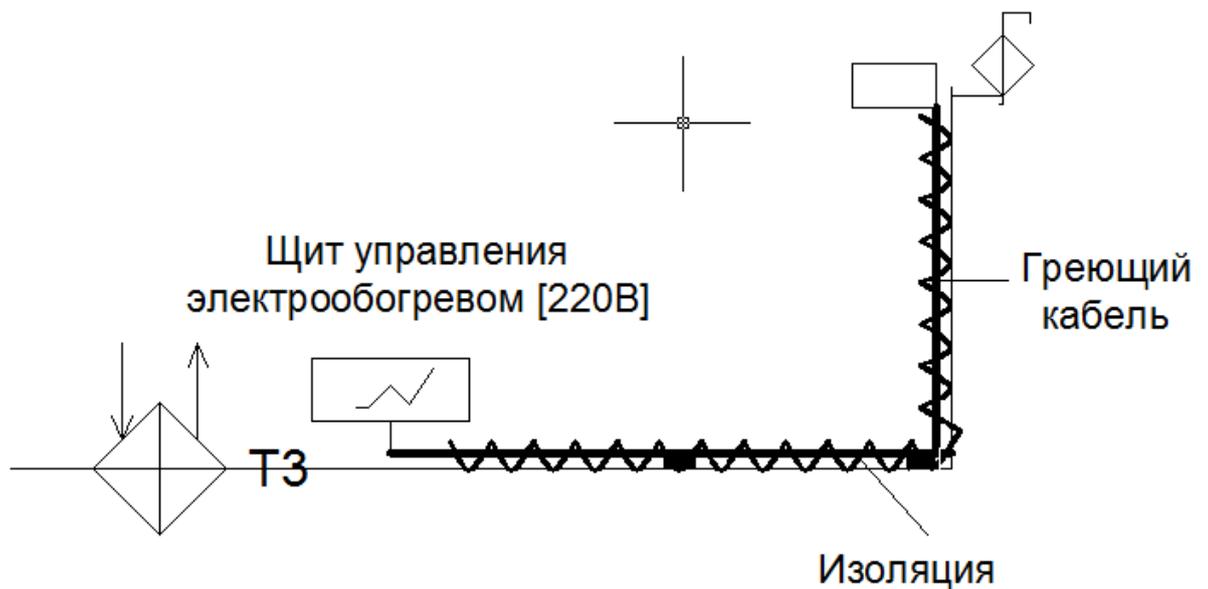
Схема горячего водоснабжения с греющим кабелем
